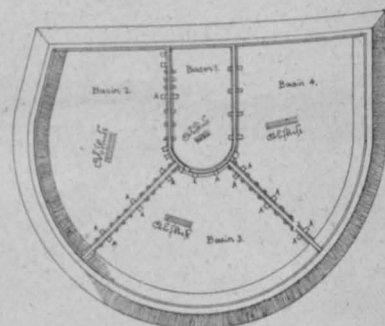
Grundriss des Klärbassins in Kansas City (Mo.).
